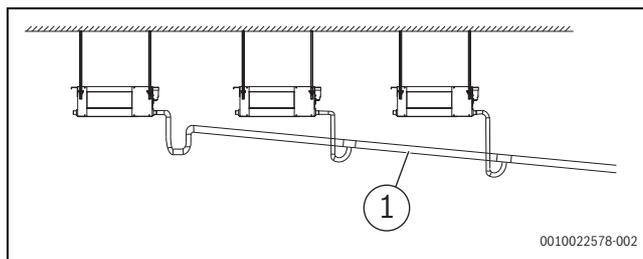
Монтаж сливного трубопровода без водяного насоса
